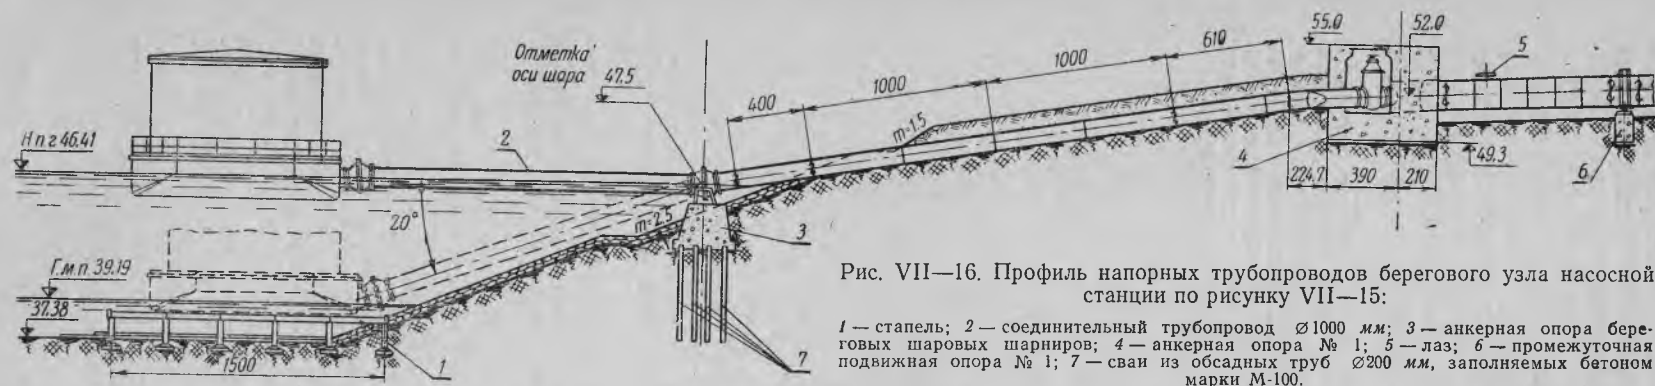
Профиль напорных трубопроводов берегового узла насосной станции по рисунку VII—15:
